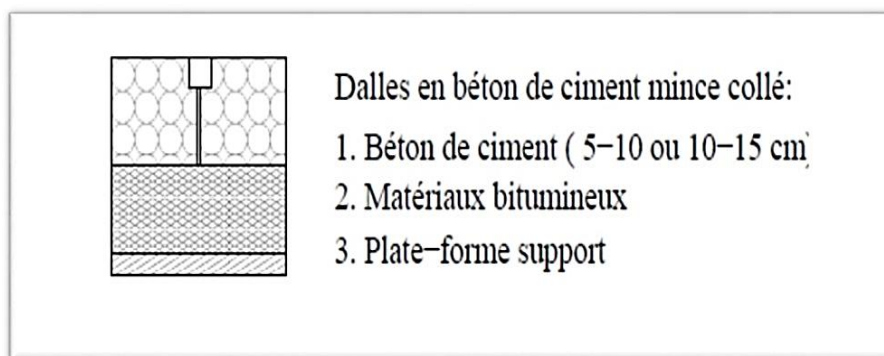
Dalles en béton de ciment mince collé. (BERGA, 2004).
